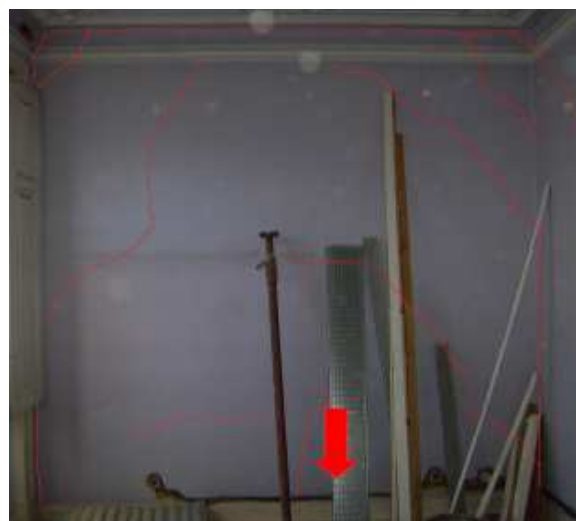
Revestimiento agrietado debido al cedimiento central del paramento en planta 1ª
